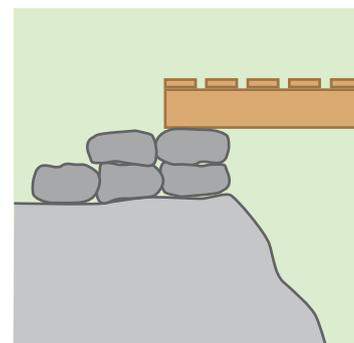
Spalla realizzata con blocchi di pietra
